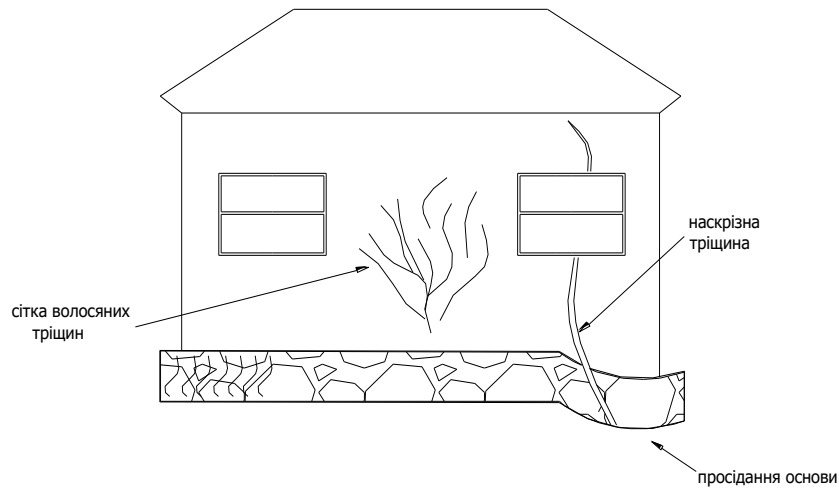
Пошкодження правого бокового фасаду будівлі
